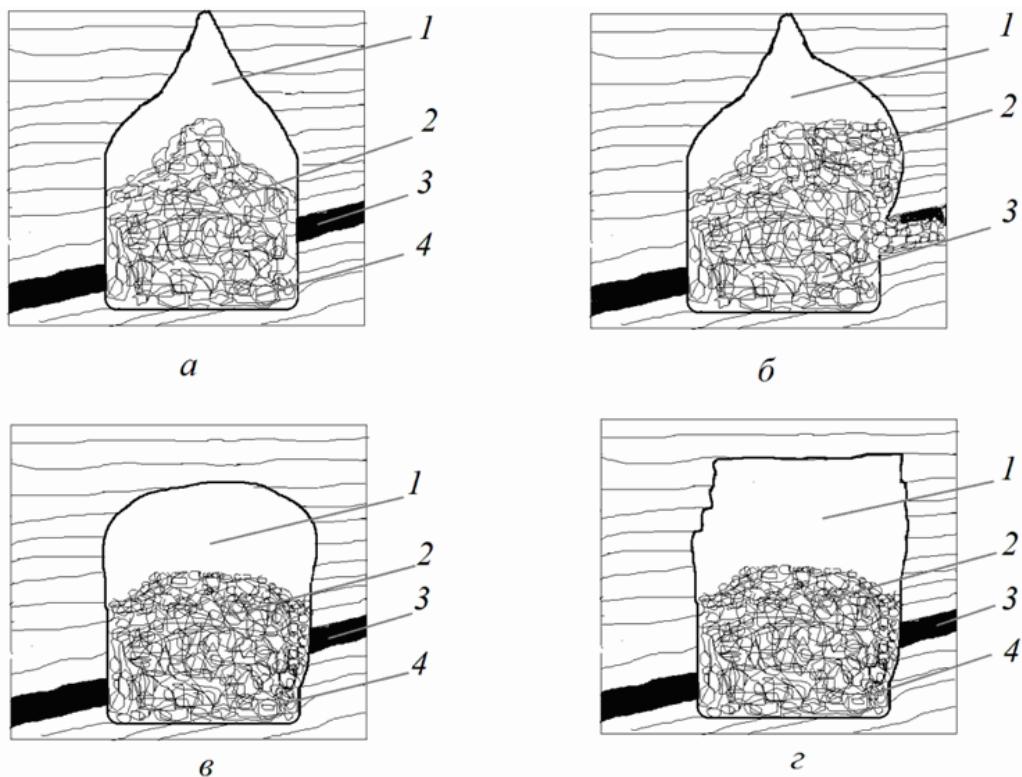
Свод обрушения кровли в подготовительной выработке: *а* – при слабых породах без смещения; *б* – при слабых породах со смещением; *в* – при крепких породах кровли; *г* – при наличии в кровле устойчивой породной пачки
